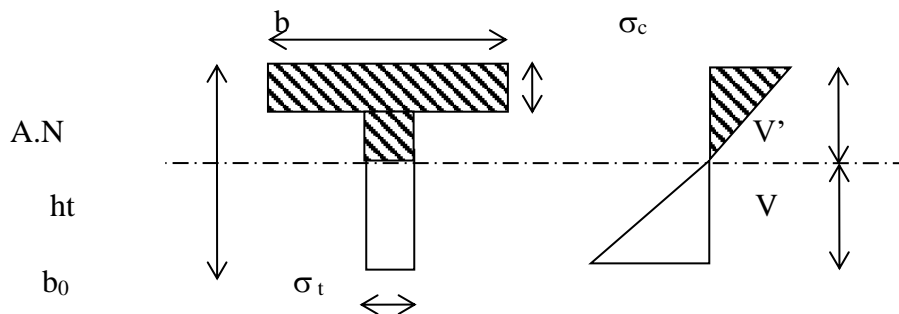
Notation utilisées pour le calcul de section d'acier pour une poutre en T
